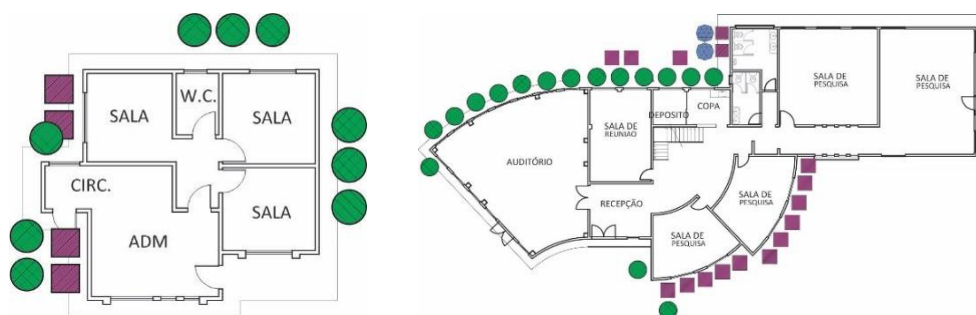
Planta Casa Ecológica e Planta Prédio Principal - Mapeamento de Danos Fonte: Autora
